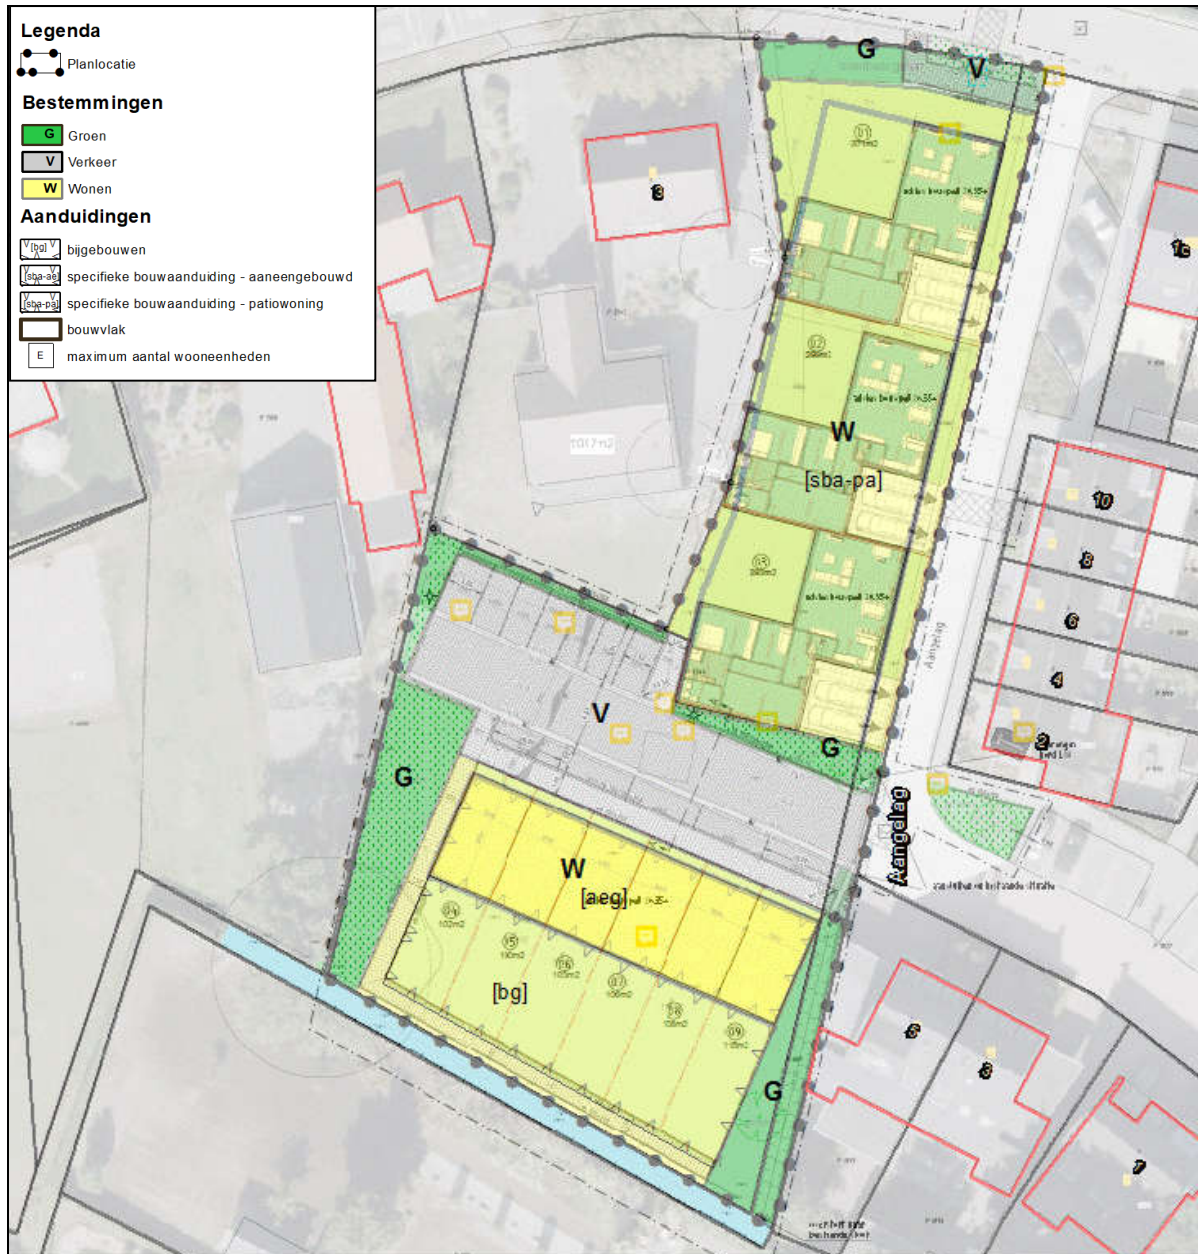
Verkaveling plangebied 't Hoekske' (Hans Goossens Architect)
